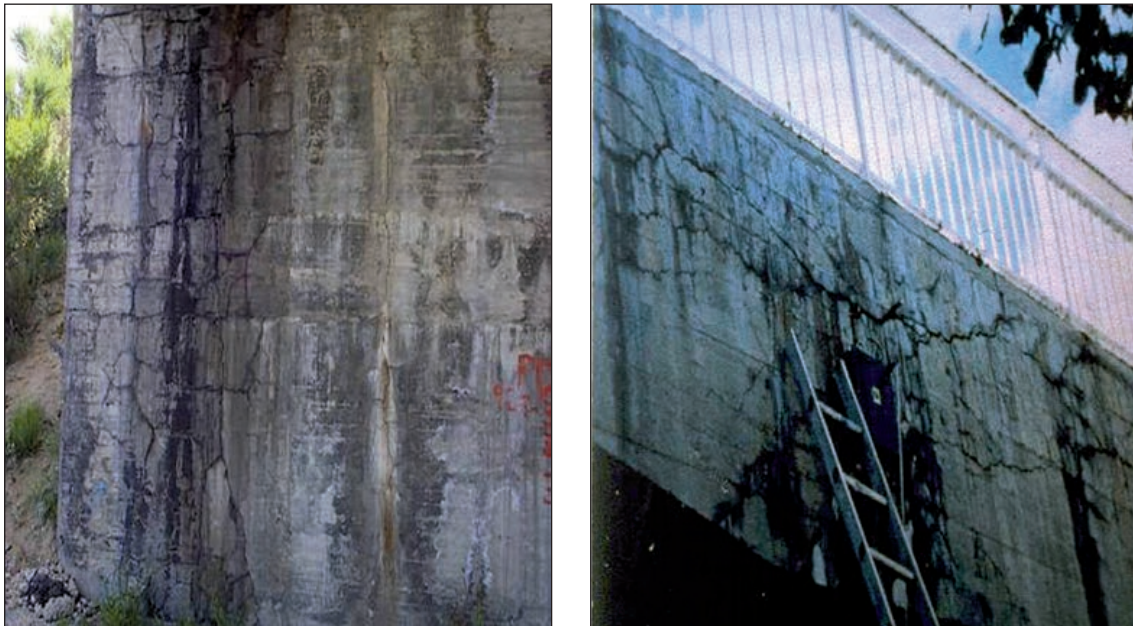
FISURACIÓN EN UN ESTRIBO Y EN UN CARGADERO DE HORMIGÓN ARMADO DEBIDO A UN ATAQUE POR SULFATOS.
